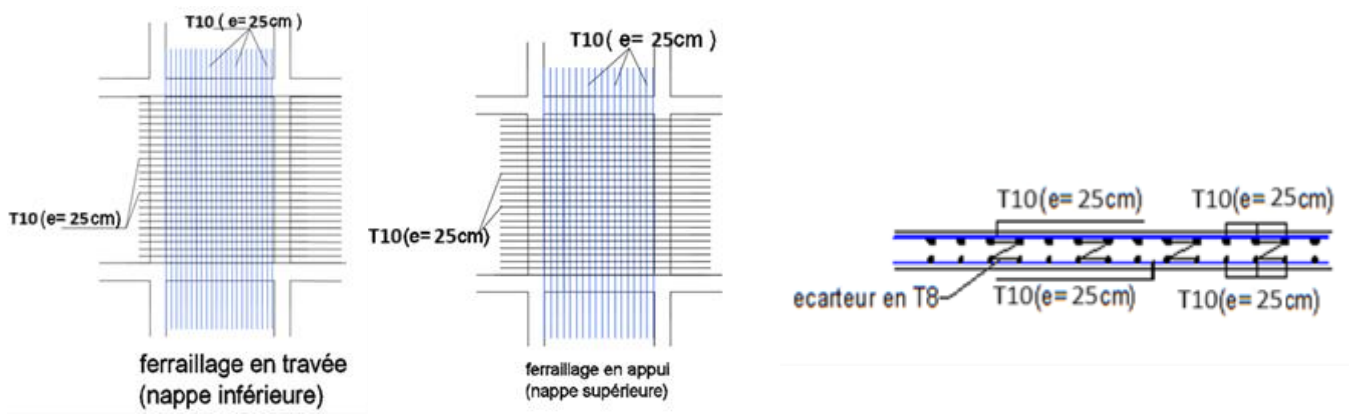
Schéma de ferrailage de la dalle pleine.
